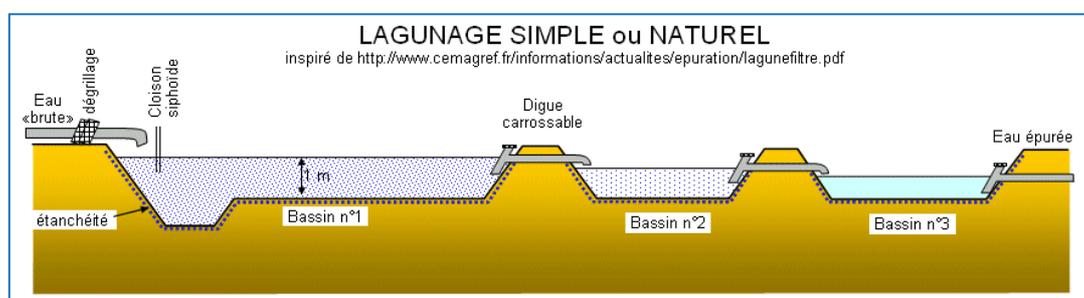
COUPE TRANSVERSALE D'UN SYSTEME CLASSIQUE DE LAGUNAGE [86]
